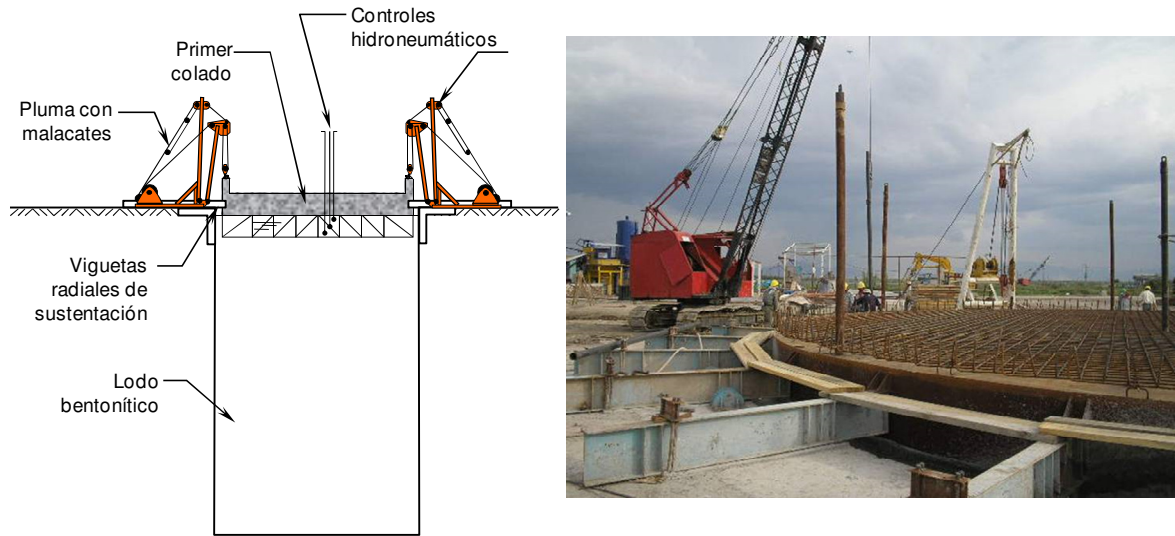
Cimbrado, armado y colocado de la losa de fondo
